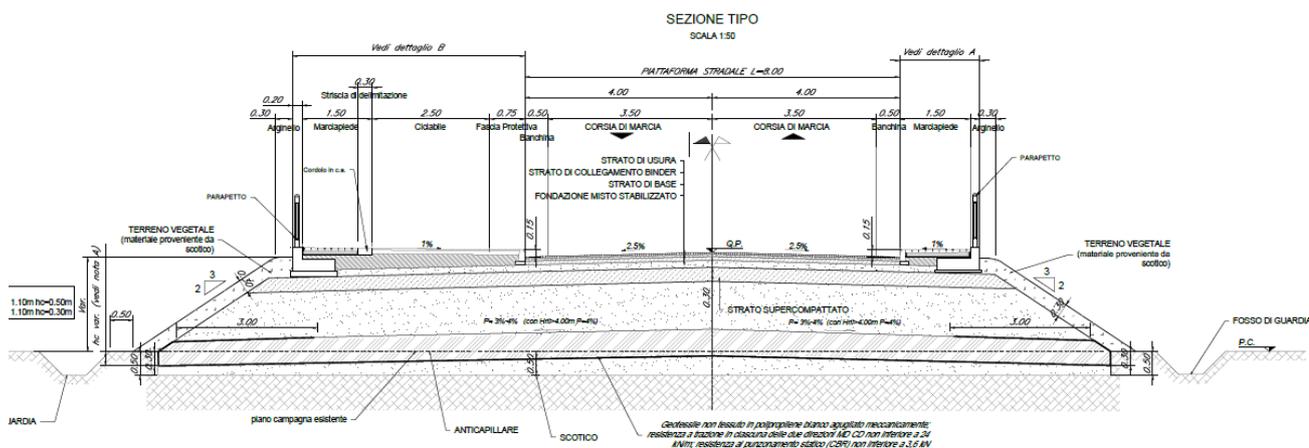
Sezione tipo della viabilità di accesso alla fermata (NV01A)
